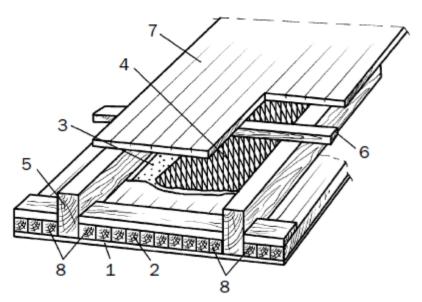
Конструкция междуэтажного перекрытия: 1 – гипсокартон; 2 – щит перекрытия; 3 – гидроизоляция; 4 – звукоизоляция; 5 – балка; 6 – лага; 7 – пол; 8 – черепные бруски
